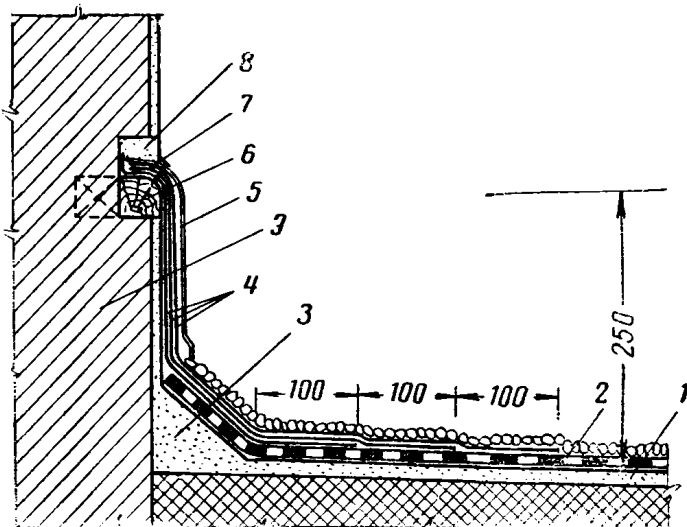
Примыкание кровли из рулонных материалов к кирпичной стене
